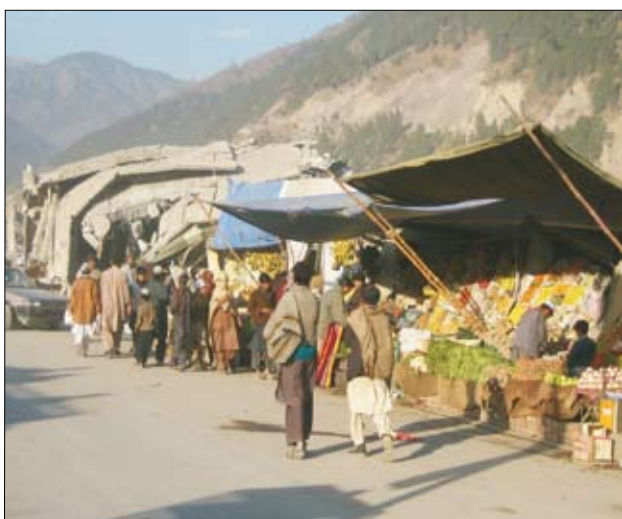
Balakot: porušena armiranobetonska konstrukcija hotela (medetažne konstrukcije so zložene kot palačinke).
